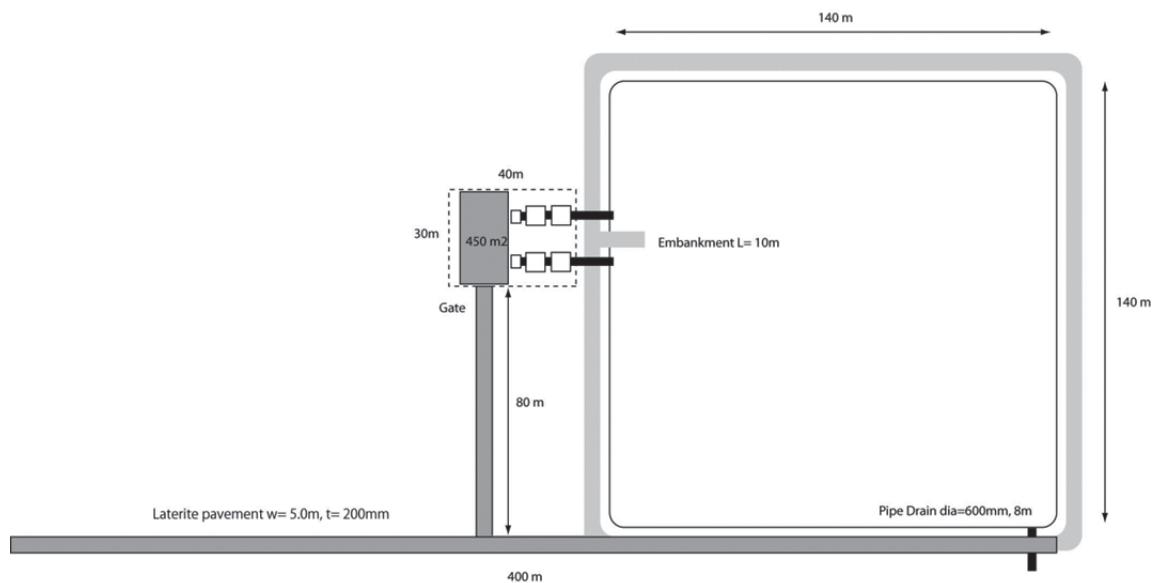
し尿浄化槽汚泥の適切処理施設の位置図
